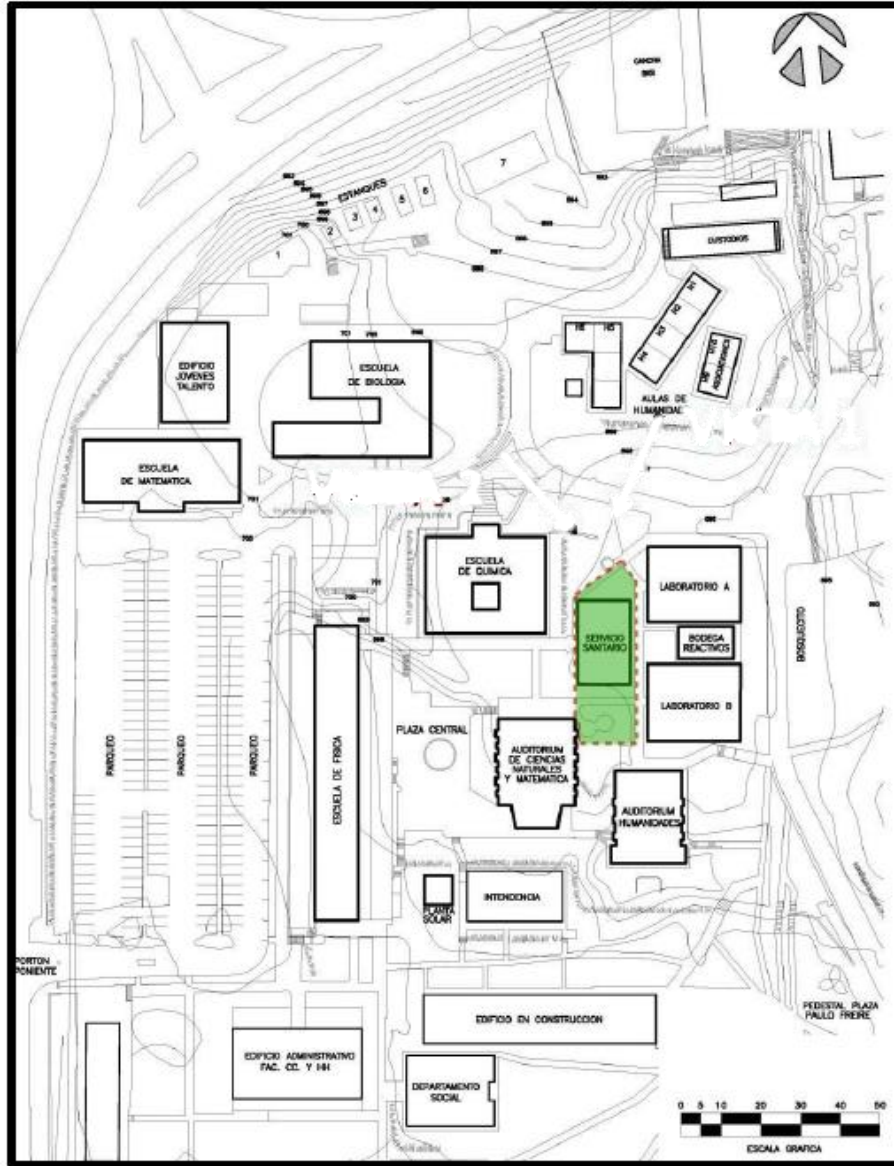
Plano de Ubicación de Terreno Alternativa 3.
